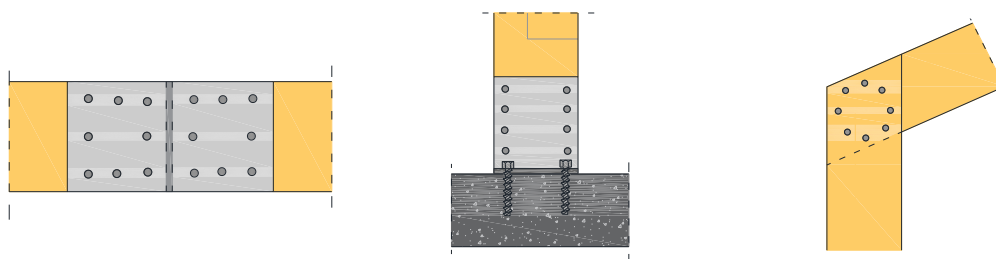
Ligações de momentos: a) viga com viga; b) uma base do pilar; c) pilar com viga [Adaptado (Kermani, 1999)].
